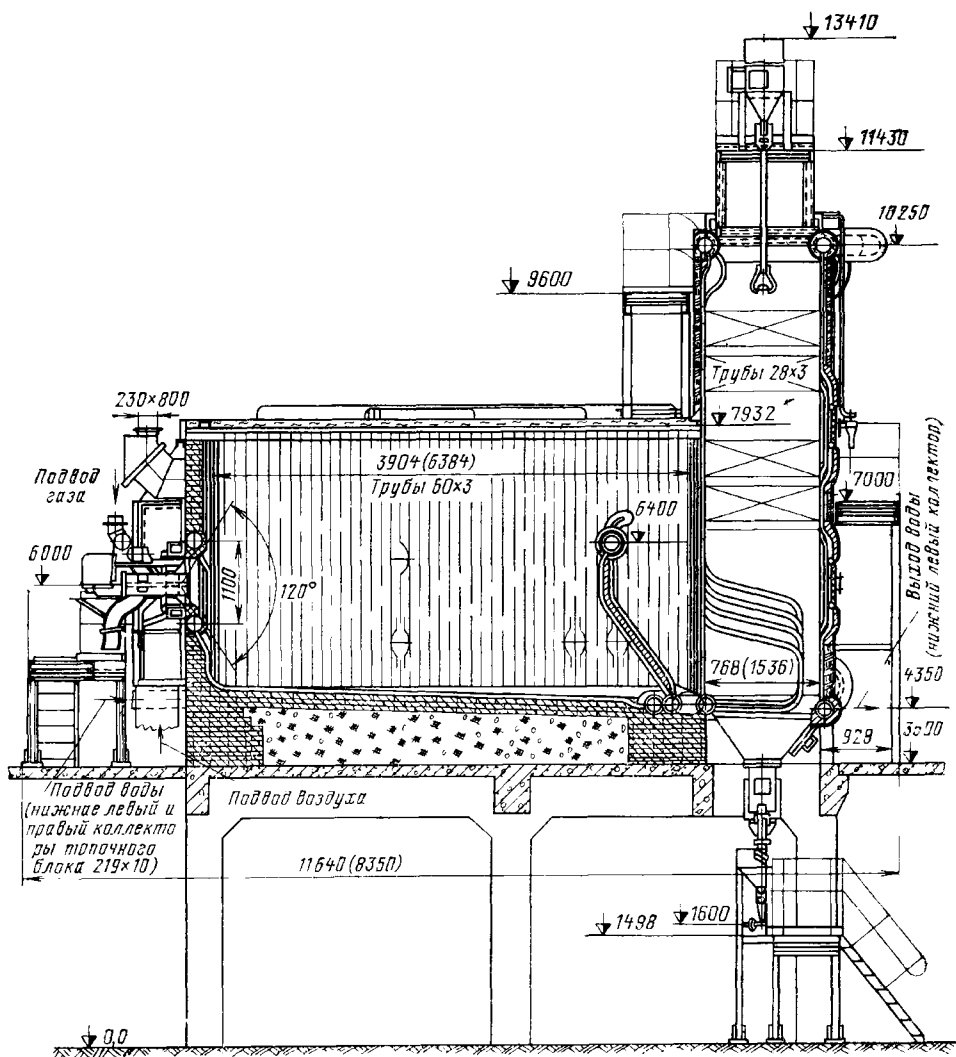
Котлоагрегаты КВ-ГМ-10 и КВ-ГМ-20 Размеры в скобках — для котлоагрегата КВ-ГМ-20
